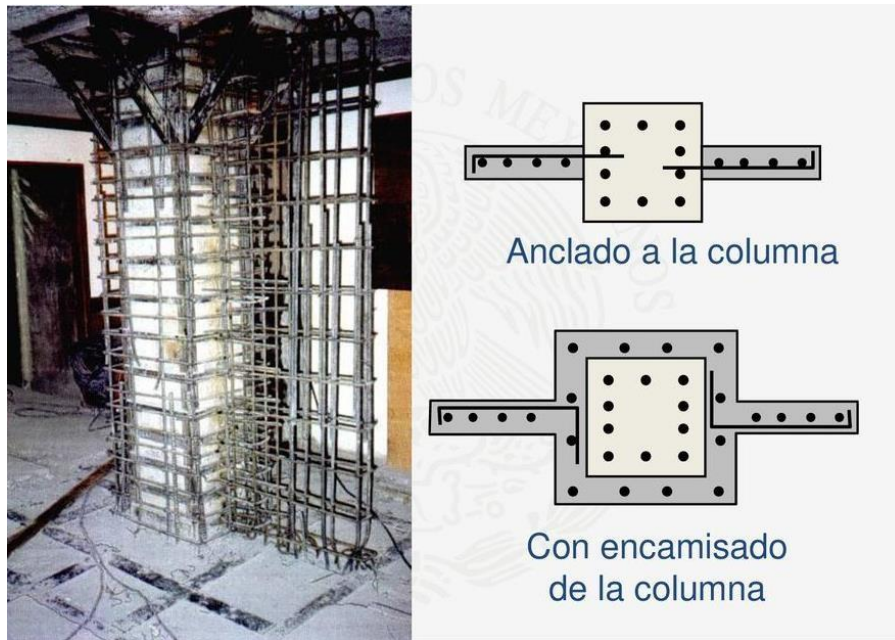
Muros tipo Wing en columnas de concreto armado y encamisado de columnas. Fuente: Retrofitting Design of Building Structures, Xilin Lu (2010).
